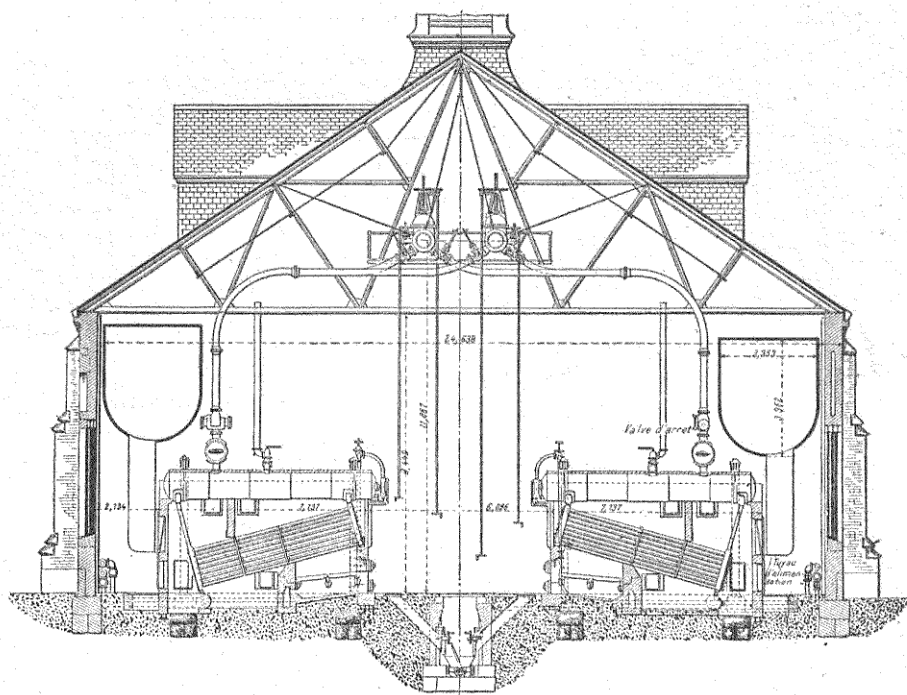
Coupe d'une station centrale. Disposition des massifs de fondation et des carnaux des gaz.
